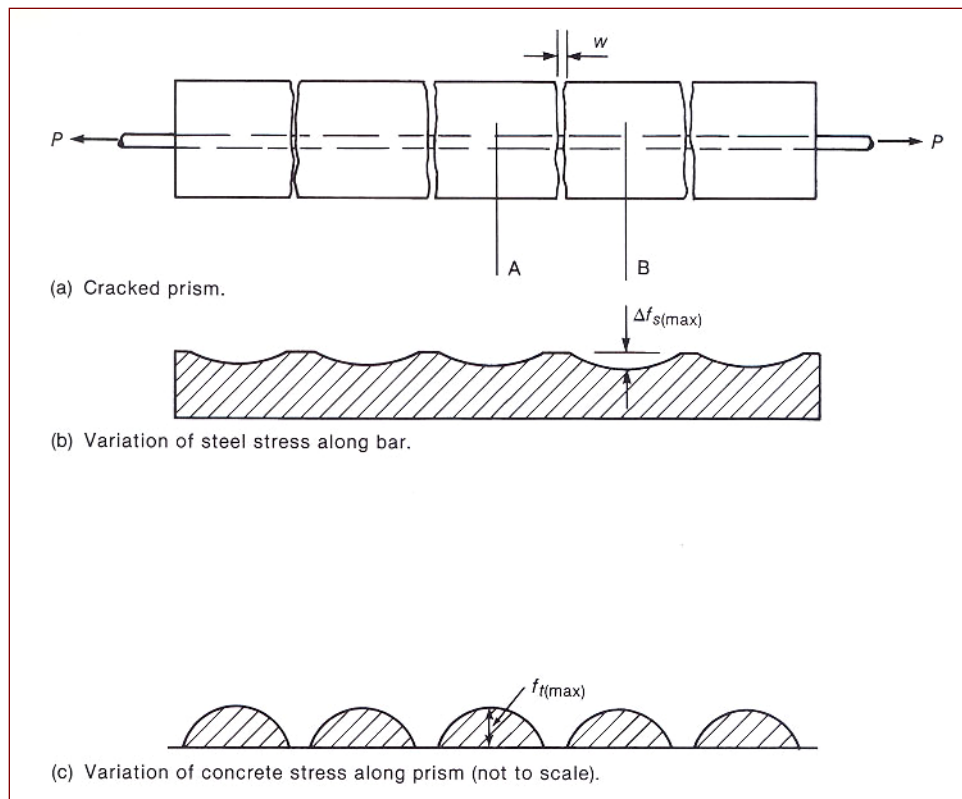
Esfuerzos en concreto y acero en un prisma agrietado.
